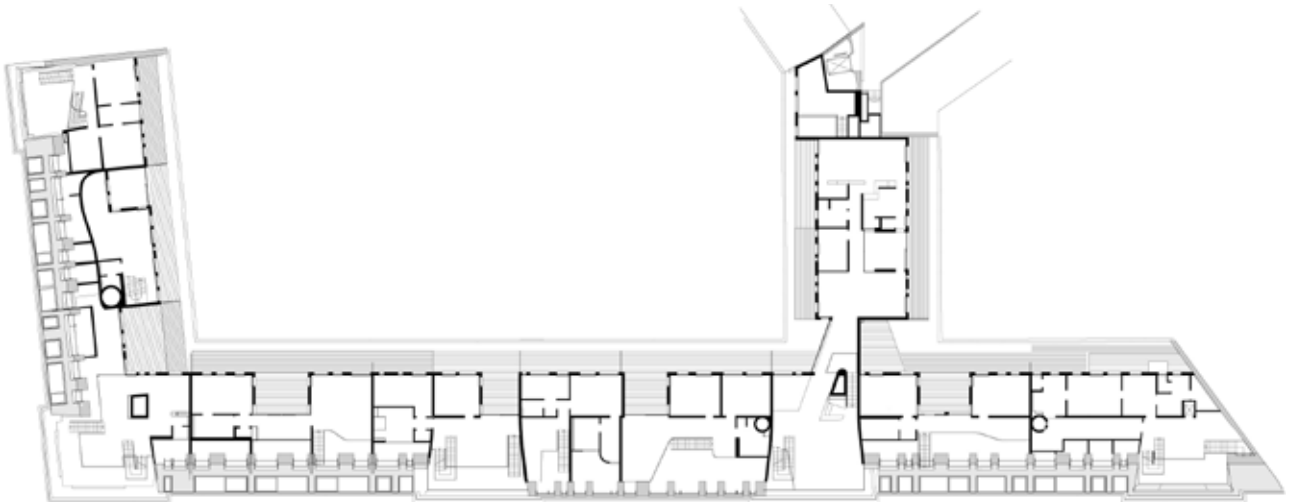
\_ Grundriss 2.DG © Boundary Silberfeil Architekten
